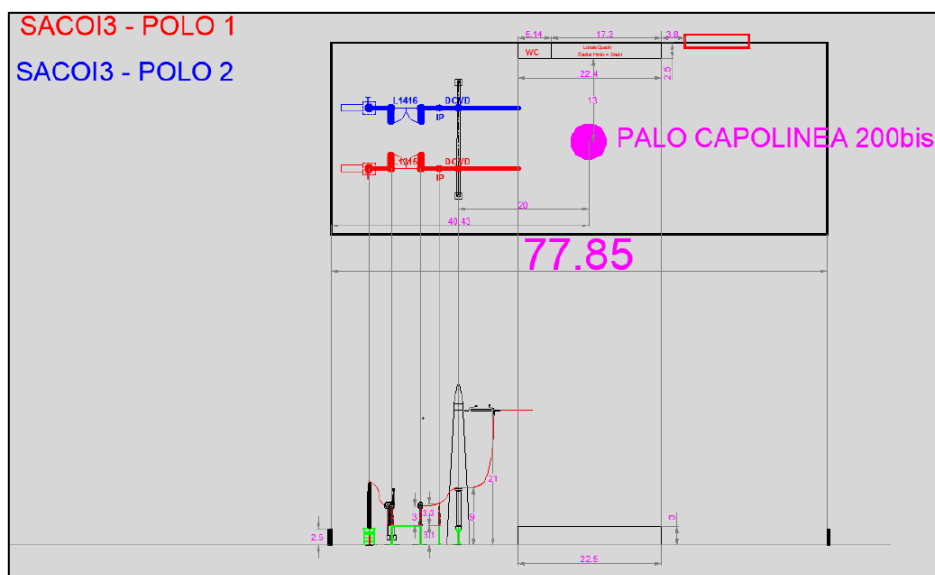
Schema collegamenti punto di transizione S.T. di Gallura in progetto
